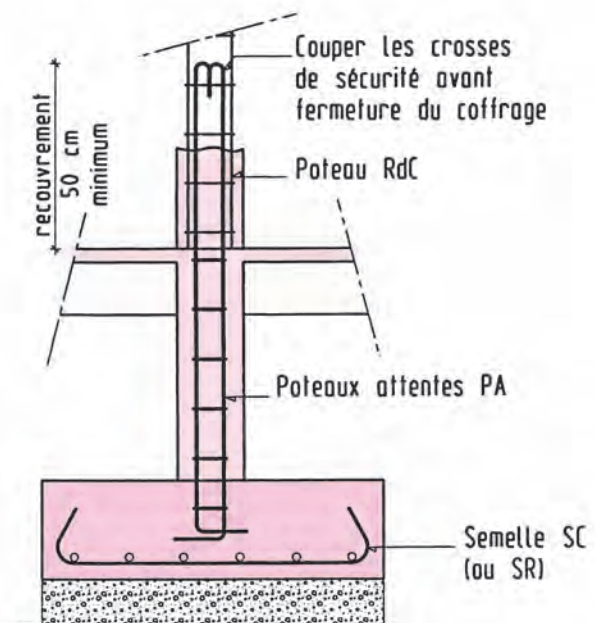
Ancrage du poteau dans la semelle isolée SC95
